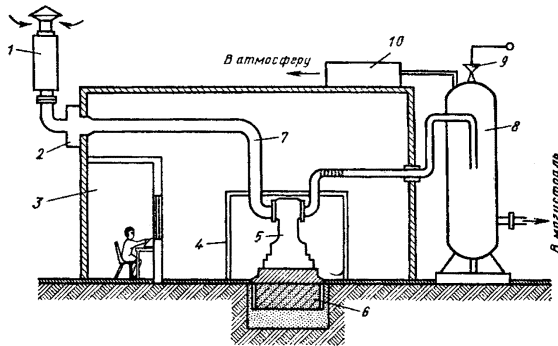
Схема комплекса шумоглушащих устройств для компрессорной станции, оборудованной поршневыми компрессорами:
